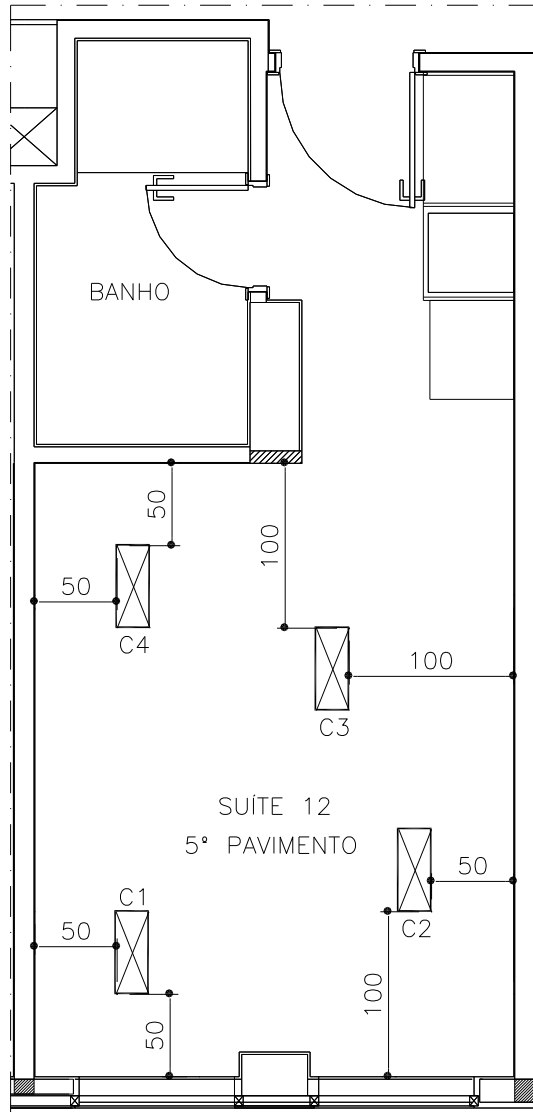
Planta do ambiente de ensaio contendo posições da fonte sonora (Suíte de Ensaio – pavimento superior).
